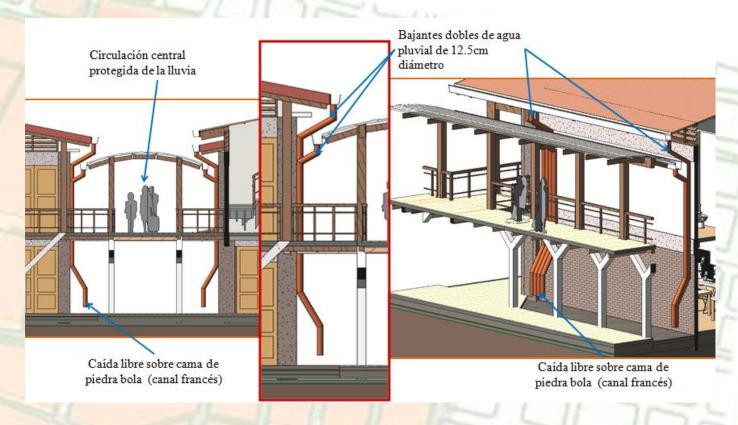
Detalle de cubierta central y bajantes. Fuente: propia
